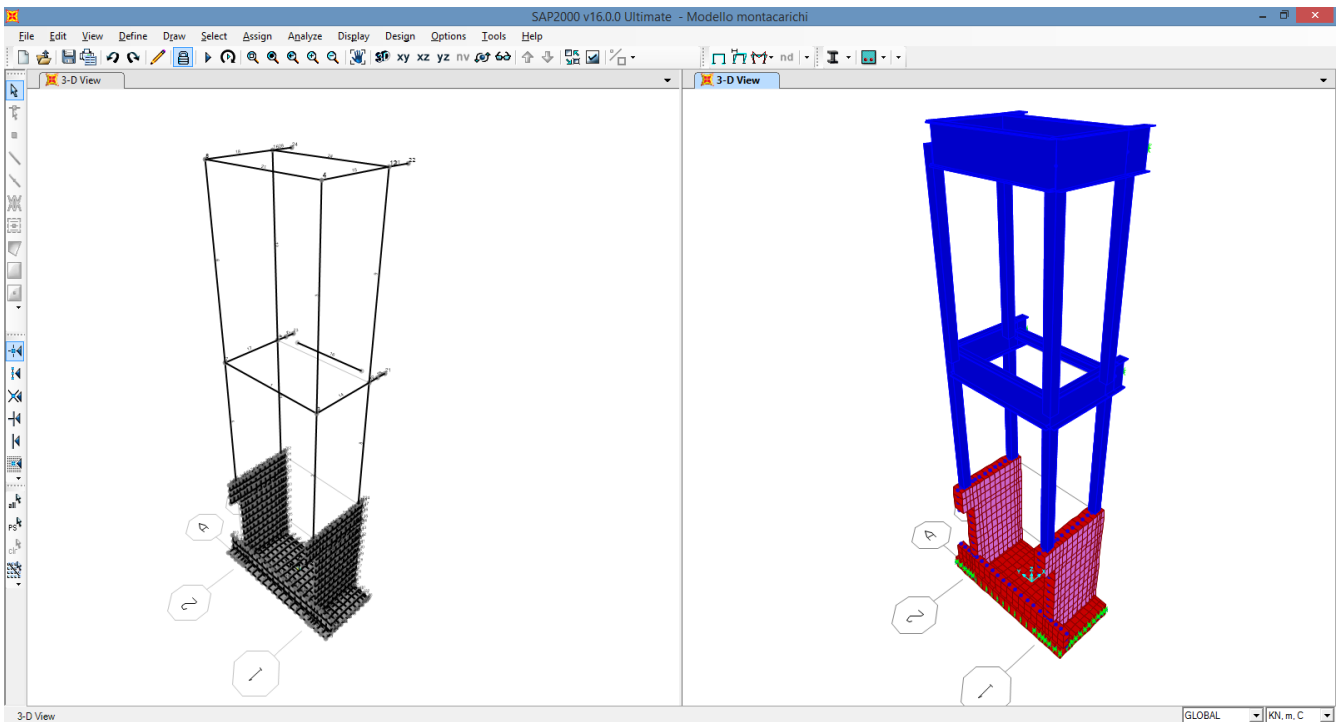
modello di calcolo completo di fondazioni su suolo alla Winkler e vincolato alla struttura esistente
